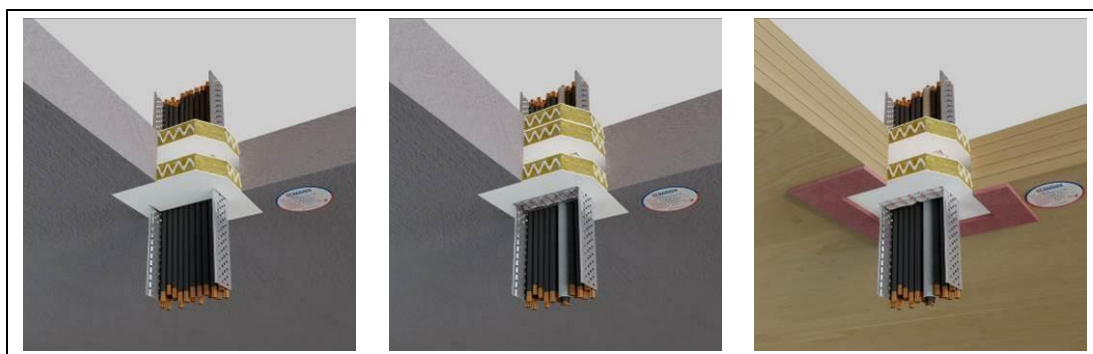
Exemple de joint de câbles électriques dans les planchers.
